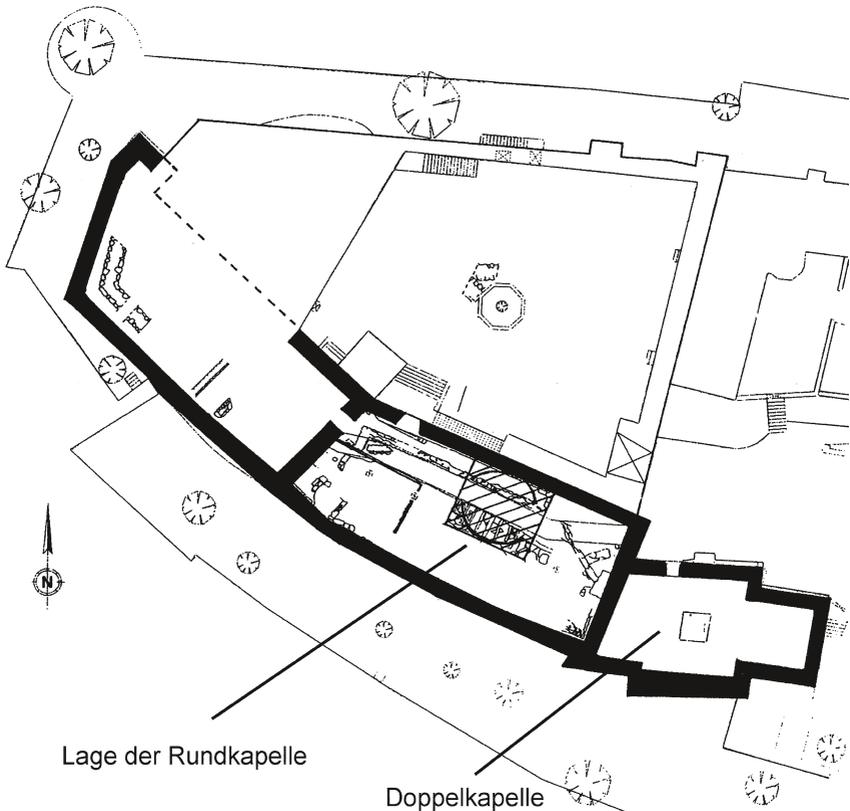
Nürnberger Burg. Zweiteiliger Palas mit eingebauter Rundkapelle und westlich ansetzender Doppelkapelle; Grundrissrekonstruktion der Bauphase IV (1200–1220/1226) (nach Friedel 2007, 64).
